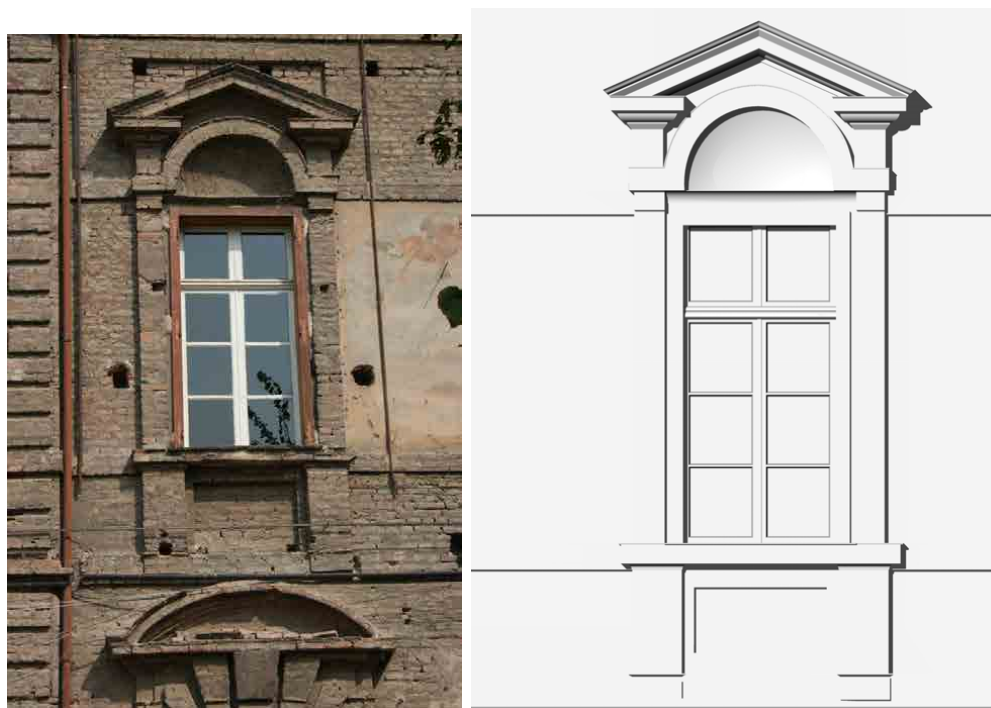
foto e prospetto del modulo architettonico in scala 1:50.
